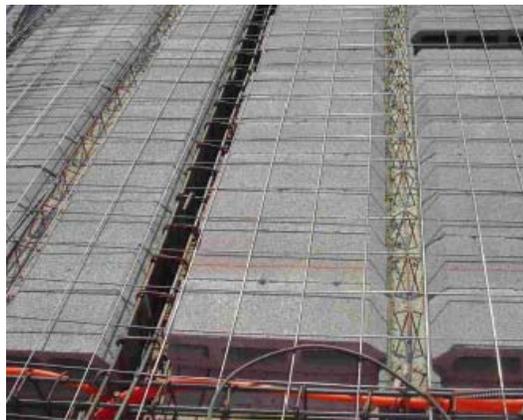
Losa compuesta por bovedillas de hormigón.
